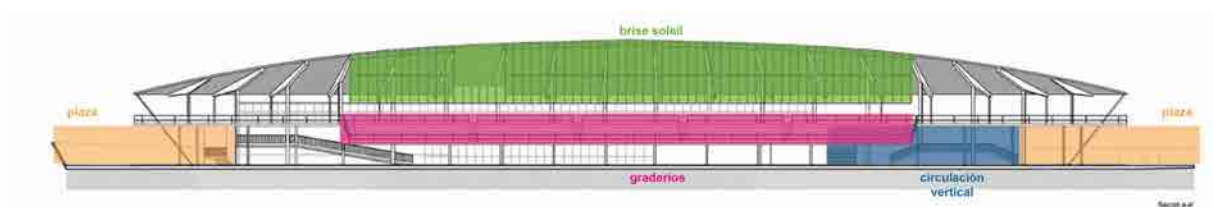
Elevación-Accesibilidad. Fuente: <https://arquitecturayempresa.es>. Elaboración: Autores.
